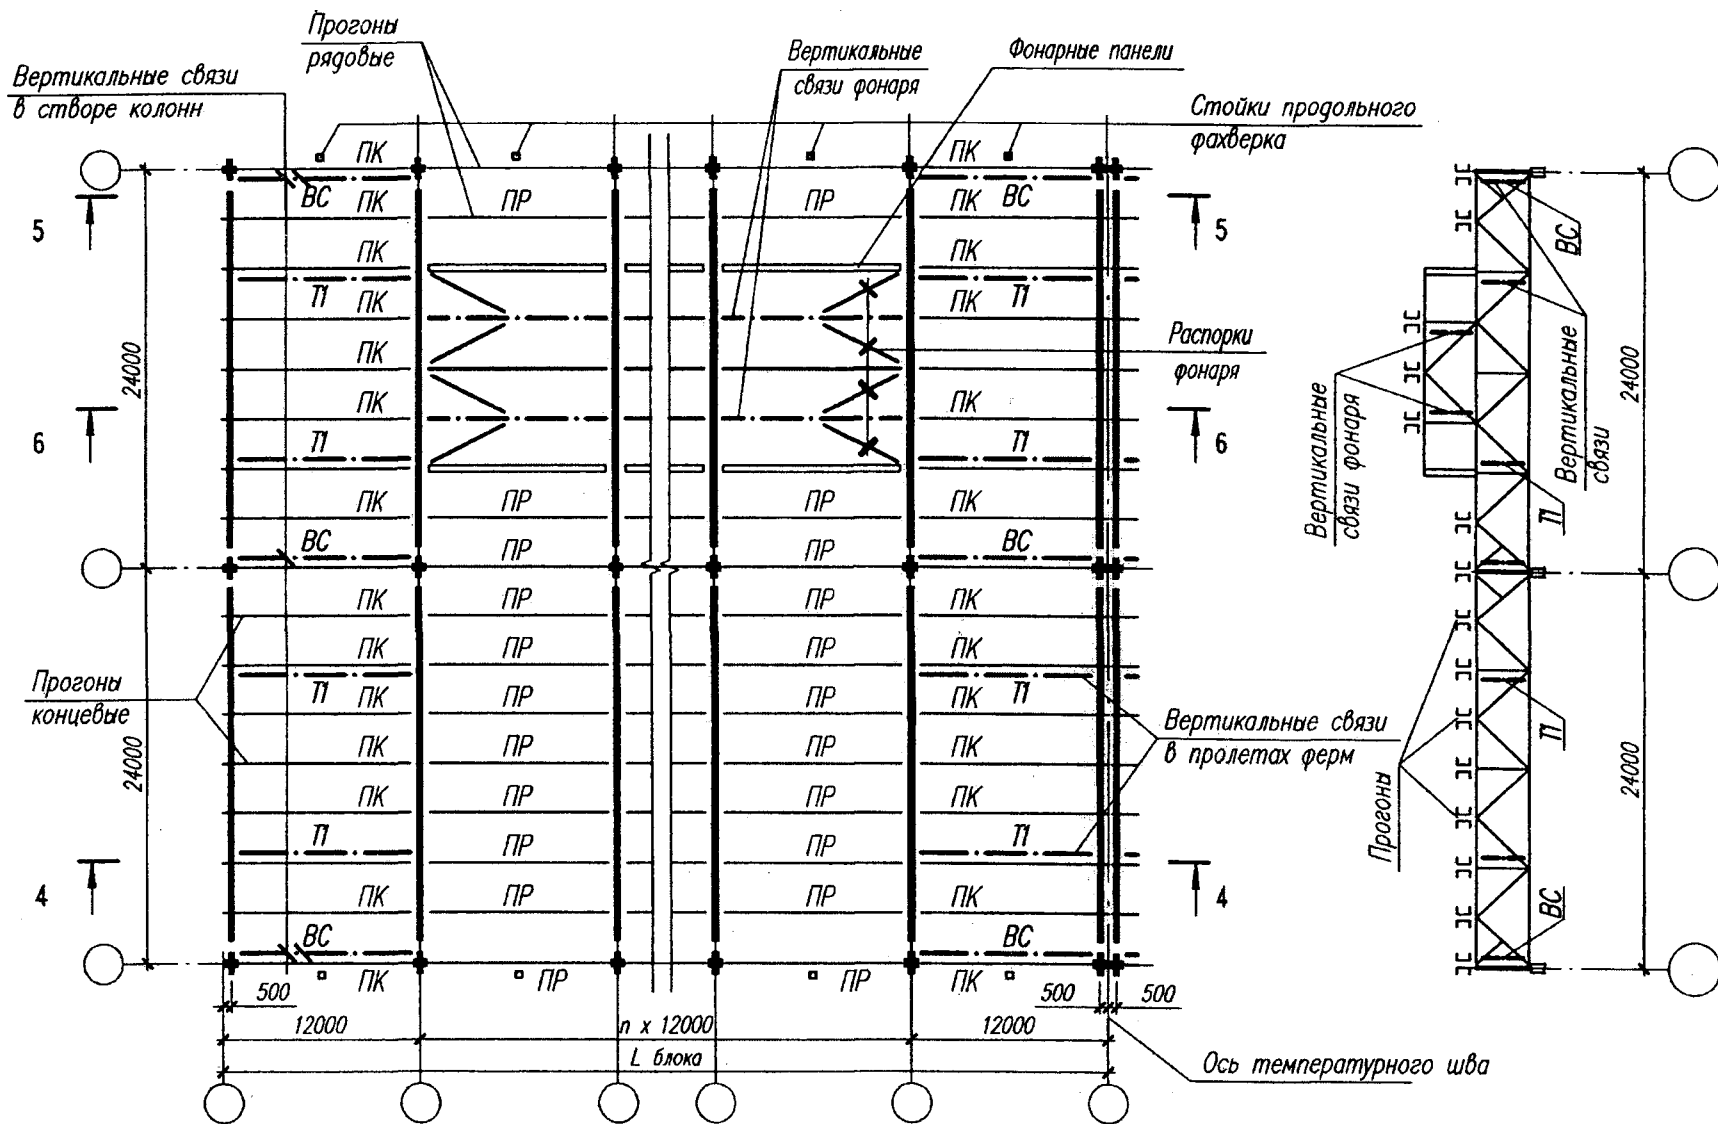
Схема расположения прогонов и связей по верхним поясам ферм (шаг ферм 12 м): шаг колонн 12 м по крайним и средним рядам, прогоны решетчатые по серии 1.462.3-17/85, покрытие из профилированного настила
